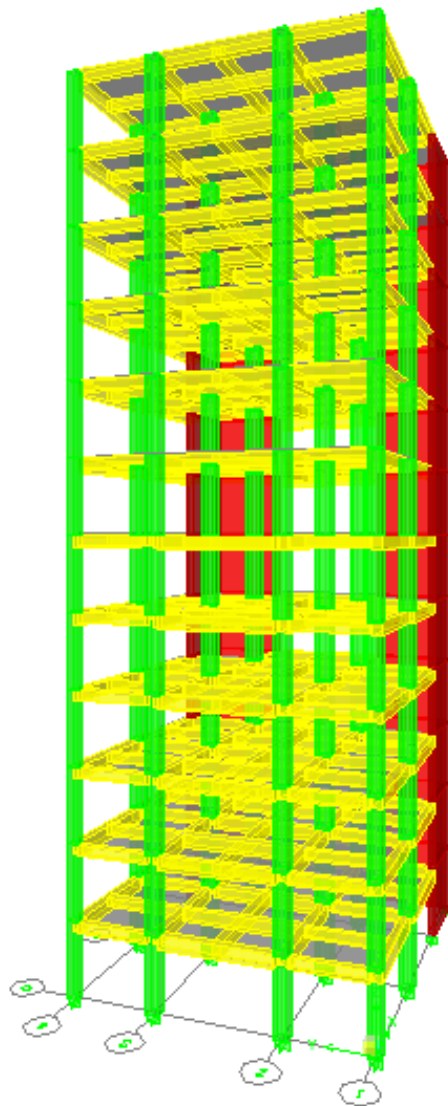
Permodelan denah lantai 2-10 (ETABS).
